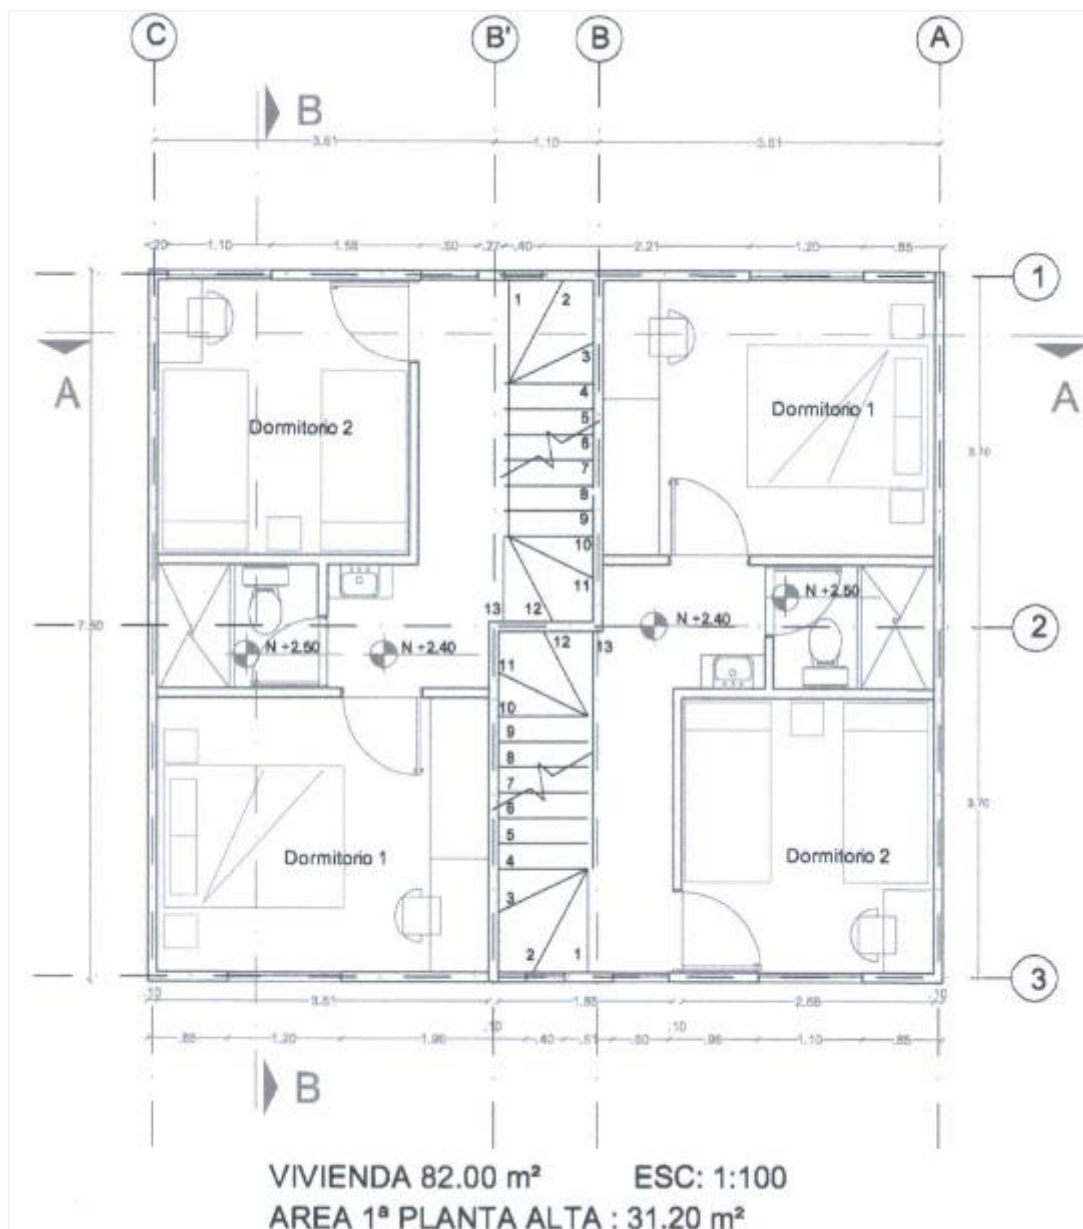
PRIMERA PLANTA de Vivienda Tipo C82CG
